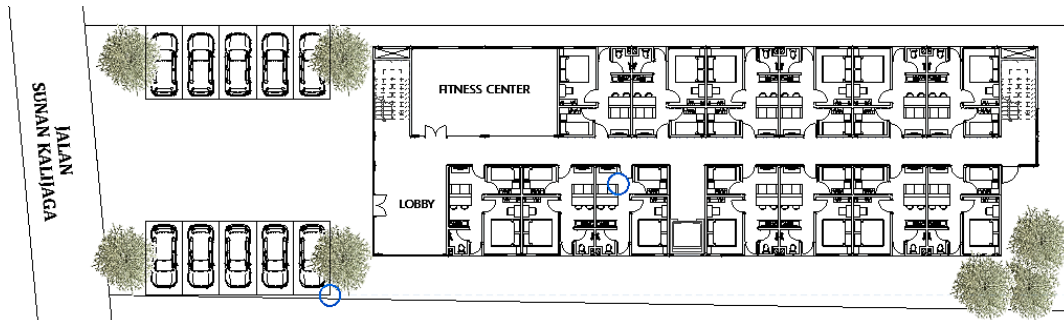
Ilustrasi Denah Unit Apartemen Studio
